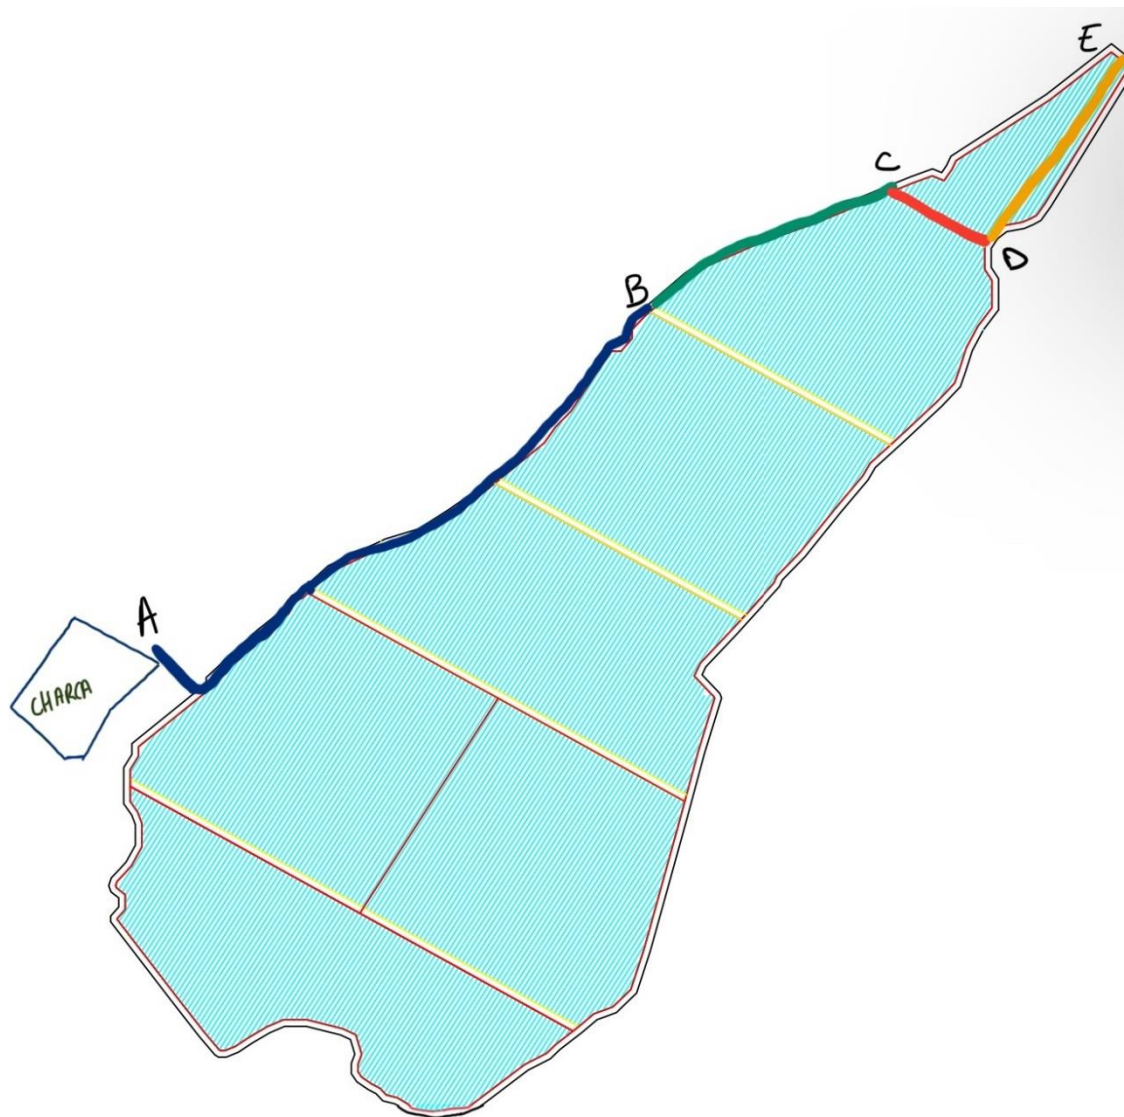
Croquis tuberías para pérdida de carga (Fuente: Elaboración propia, 2024)
